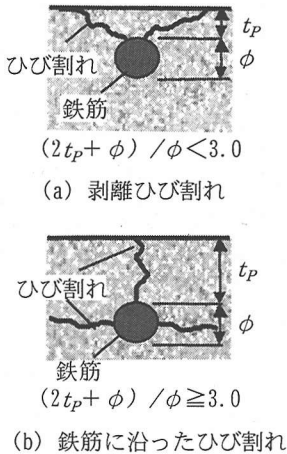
鉄筋の腐食膨張によるひび割れパターン⁴⁾
